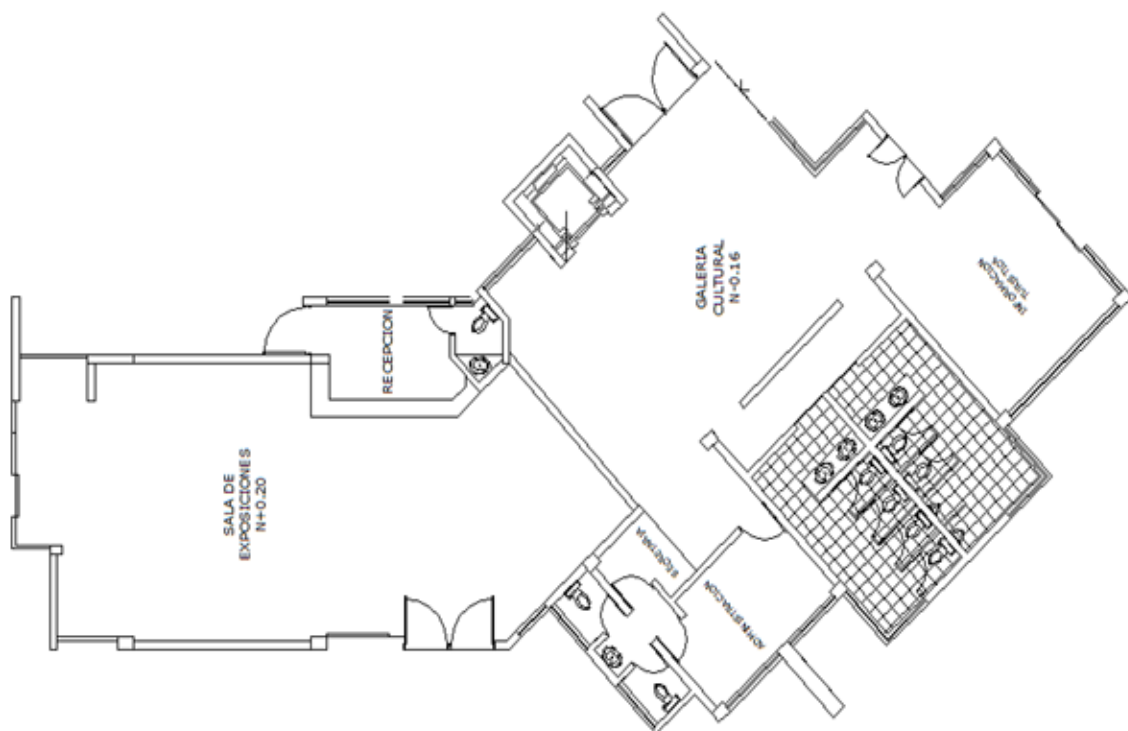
Vista en planta del centro cultural. Fuente: Diseño Autocad. Elaborado por: Marco Benalcázar
